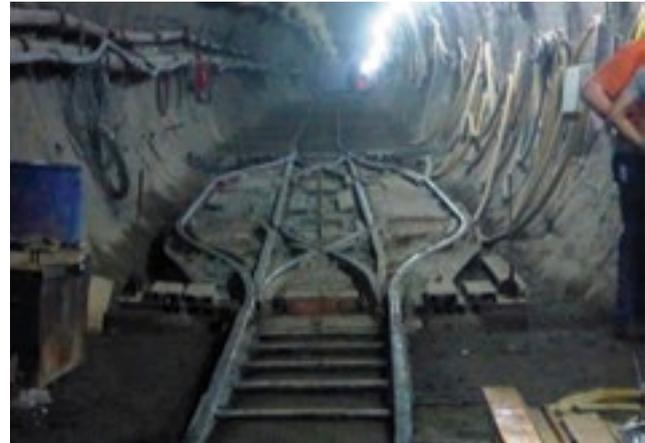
Трехходовая стрелка MASCHINENBAU MARK (www.maschinenbau-mark.de)
